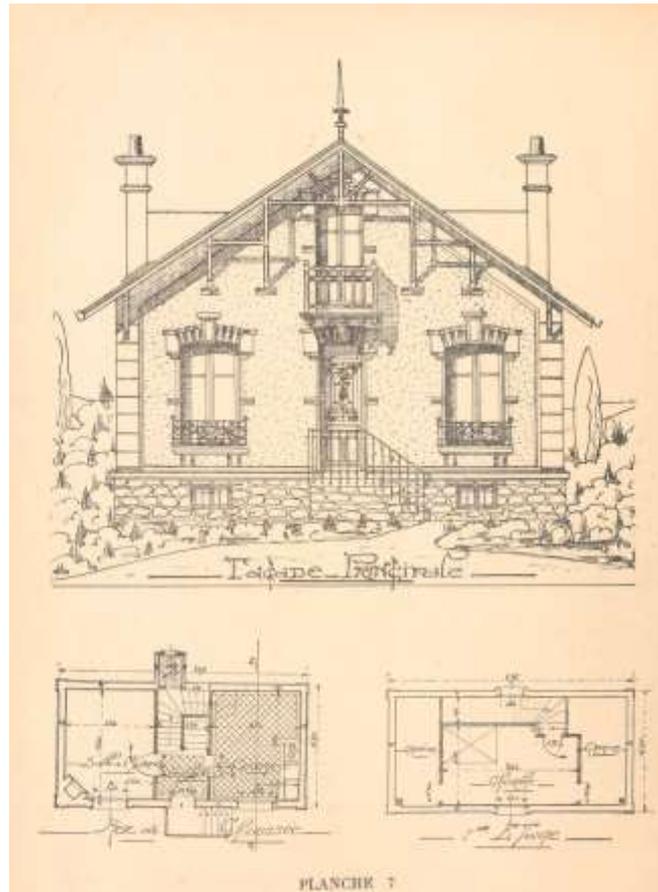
façade et plan d'un pavillon publié par Petitpas (planche 7)
